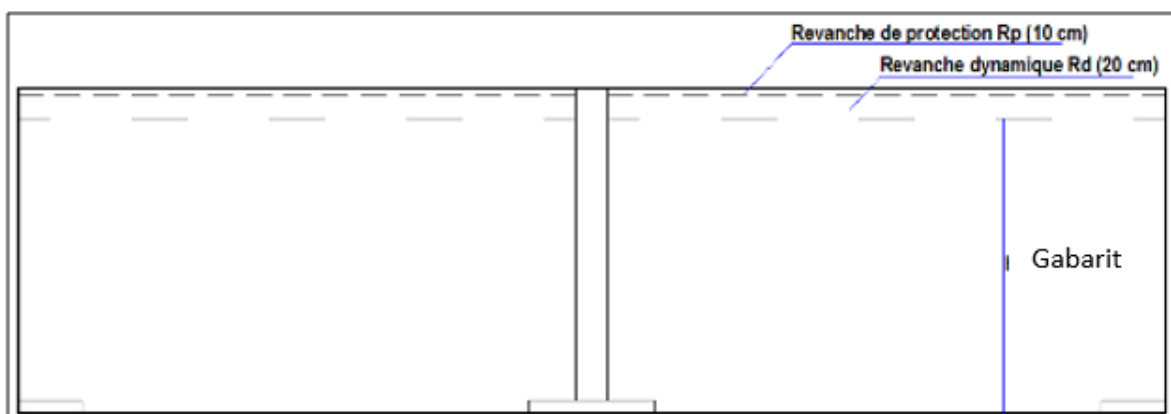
Dimensionnement de la hauteur du passage souterrain
